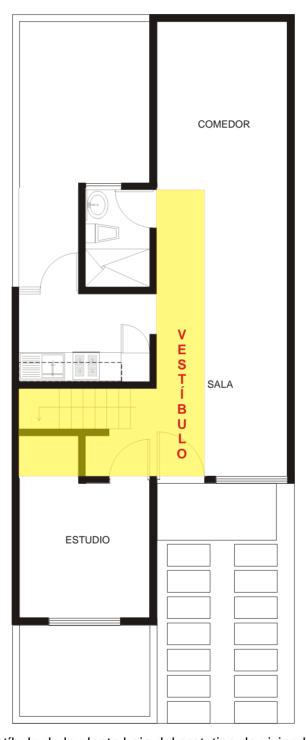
Vestíbulo de la planta baja del prototipo de vivienda. IGRR, 2008.
